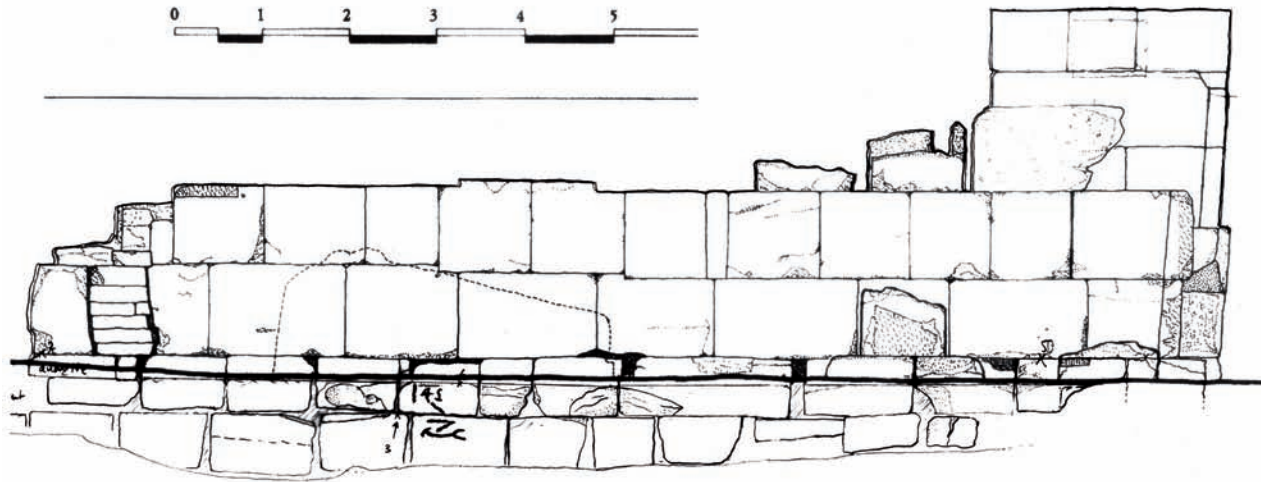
Schéma de situation des *dipinti* n^{os} 23 et 24 sur les fondations du mur de clôture sud du VI^e pylône, face ouest.
